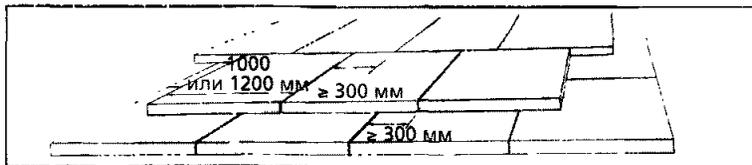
Укладка теплоизоляционных плит, не менее 300 мм внахлест.
